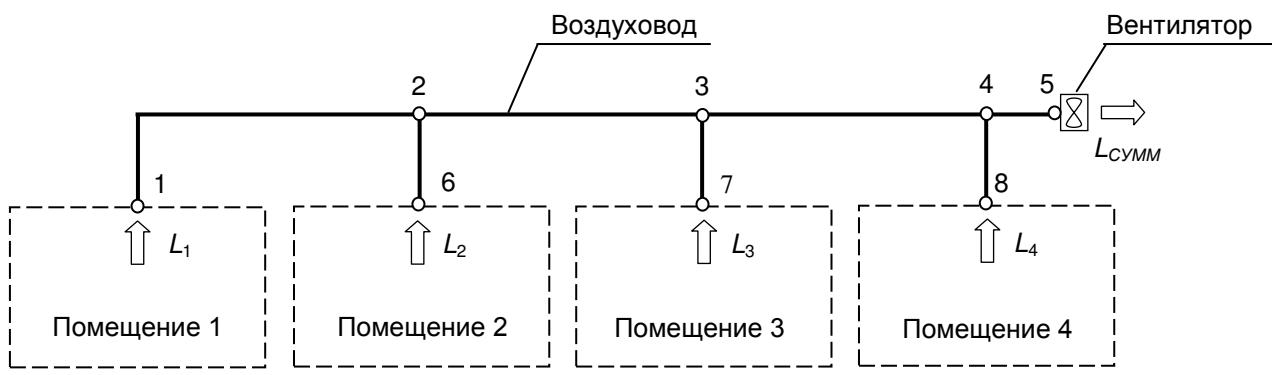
Расчетная схема системы вентиляции четырех помещений
